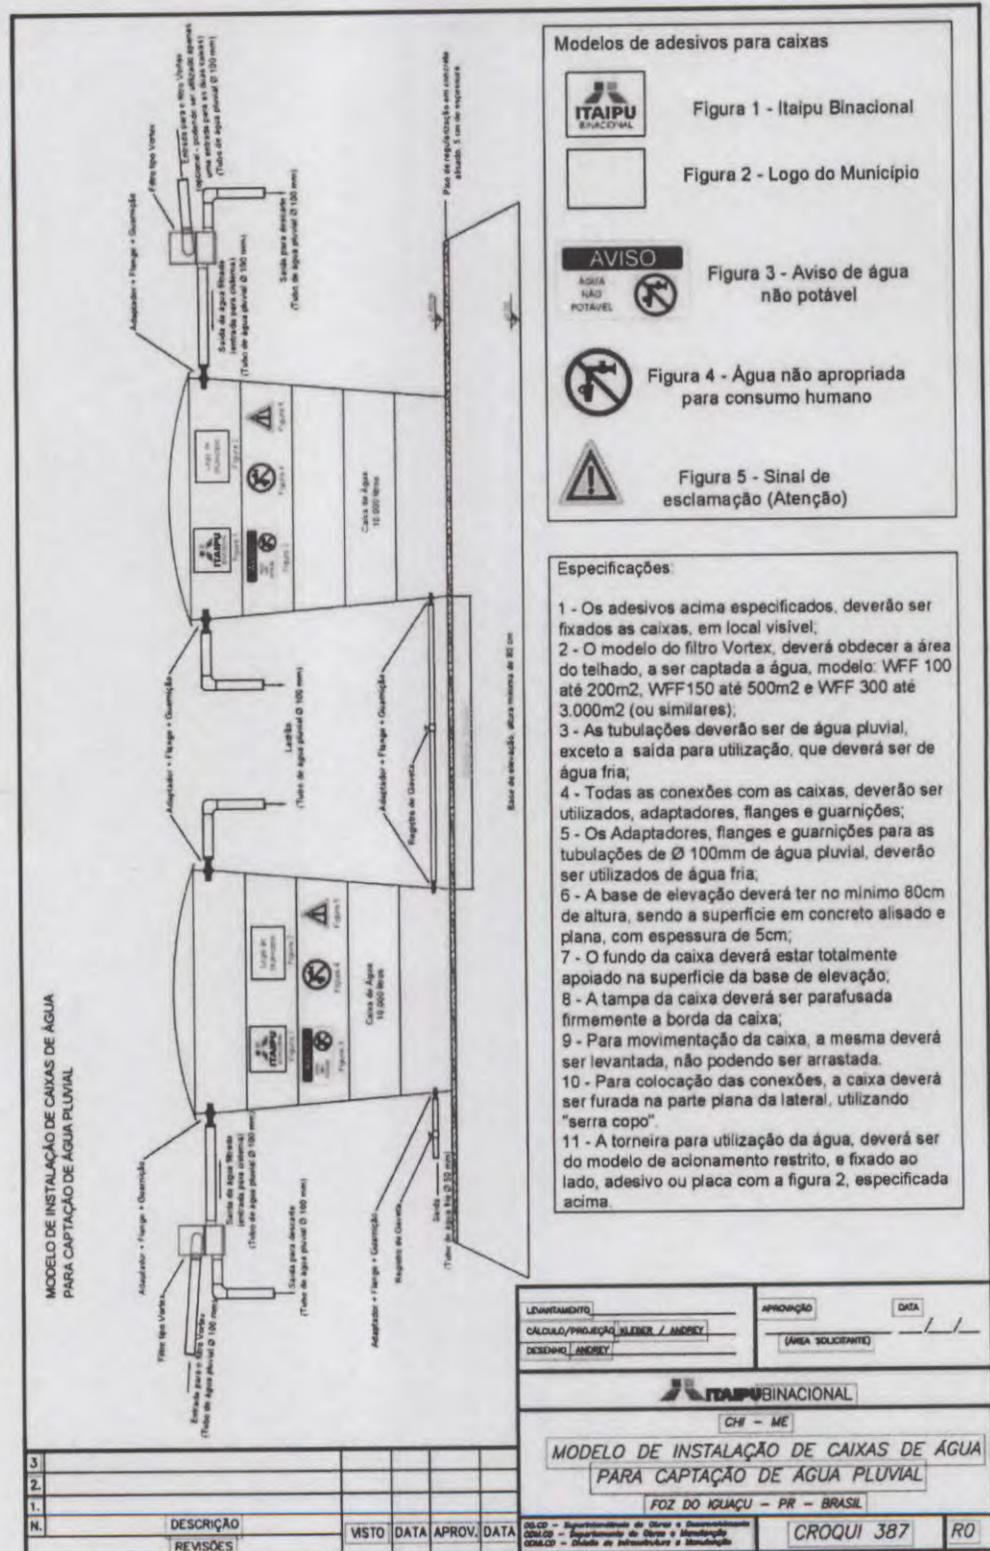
Modelo de instalação de caixa da água para captação de chuva – 20.000 Litros
